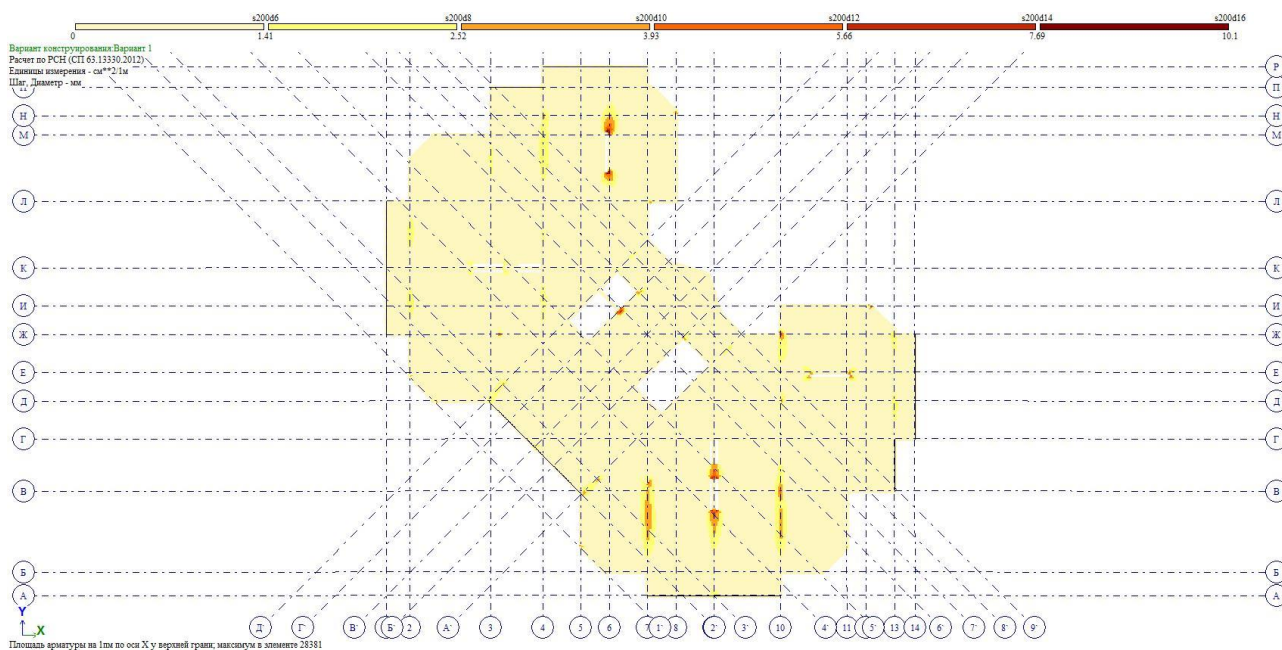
Армирование плиты монолитной верхней по оси X
